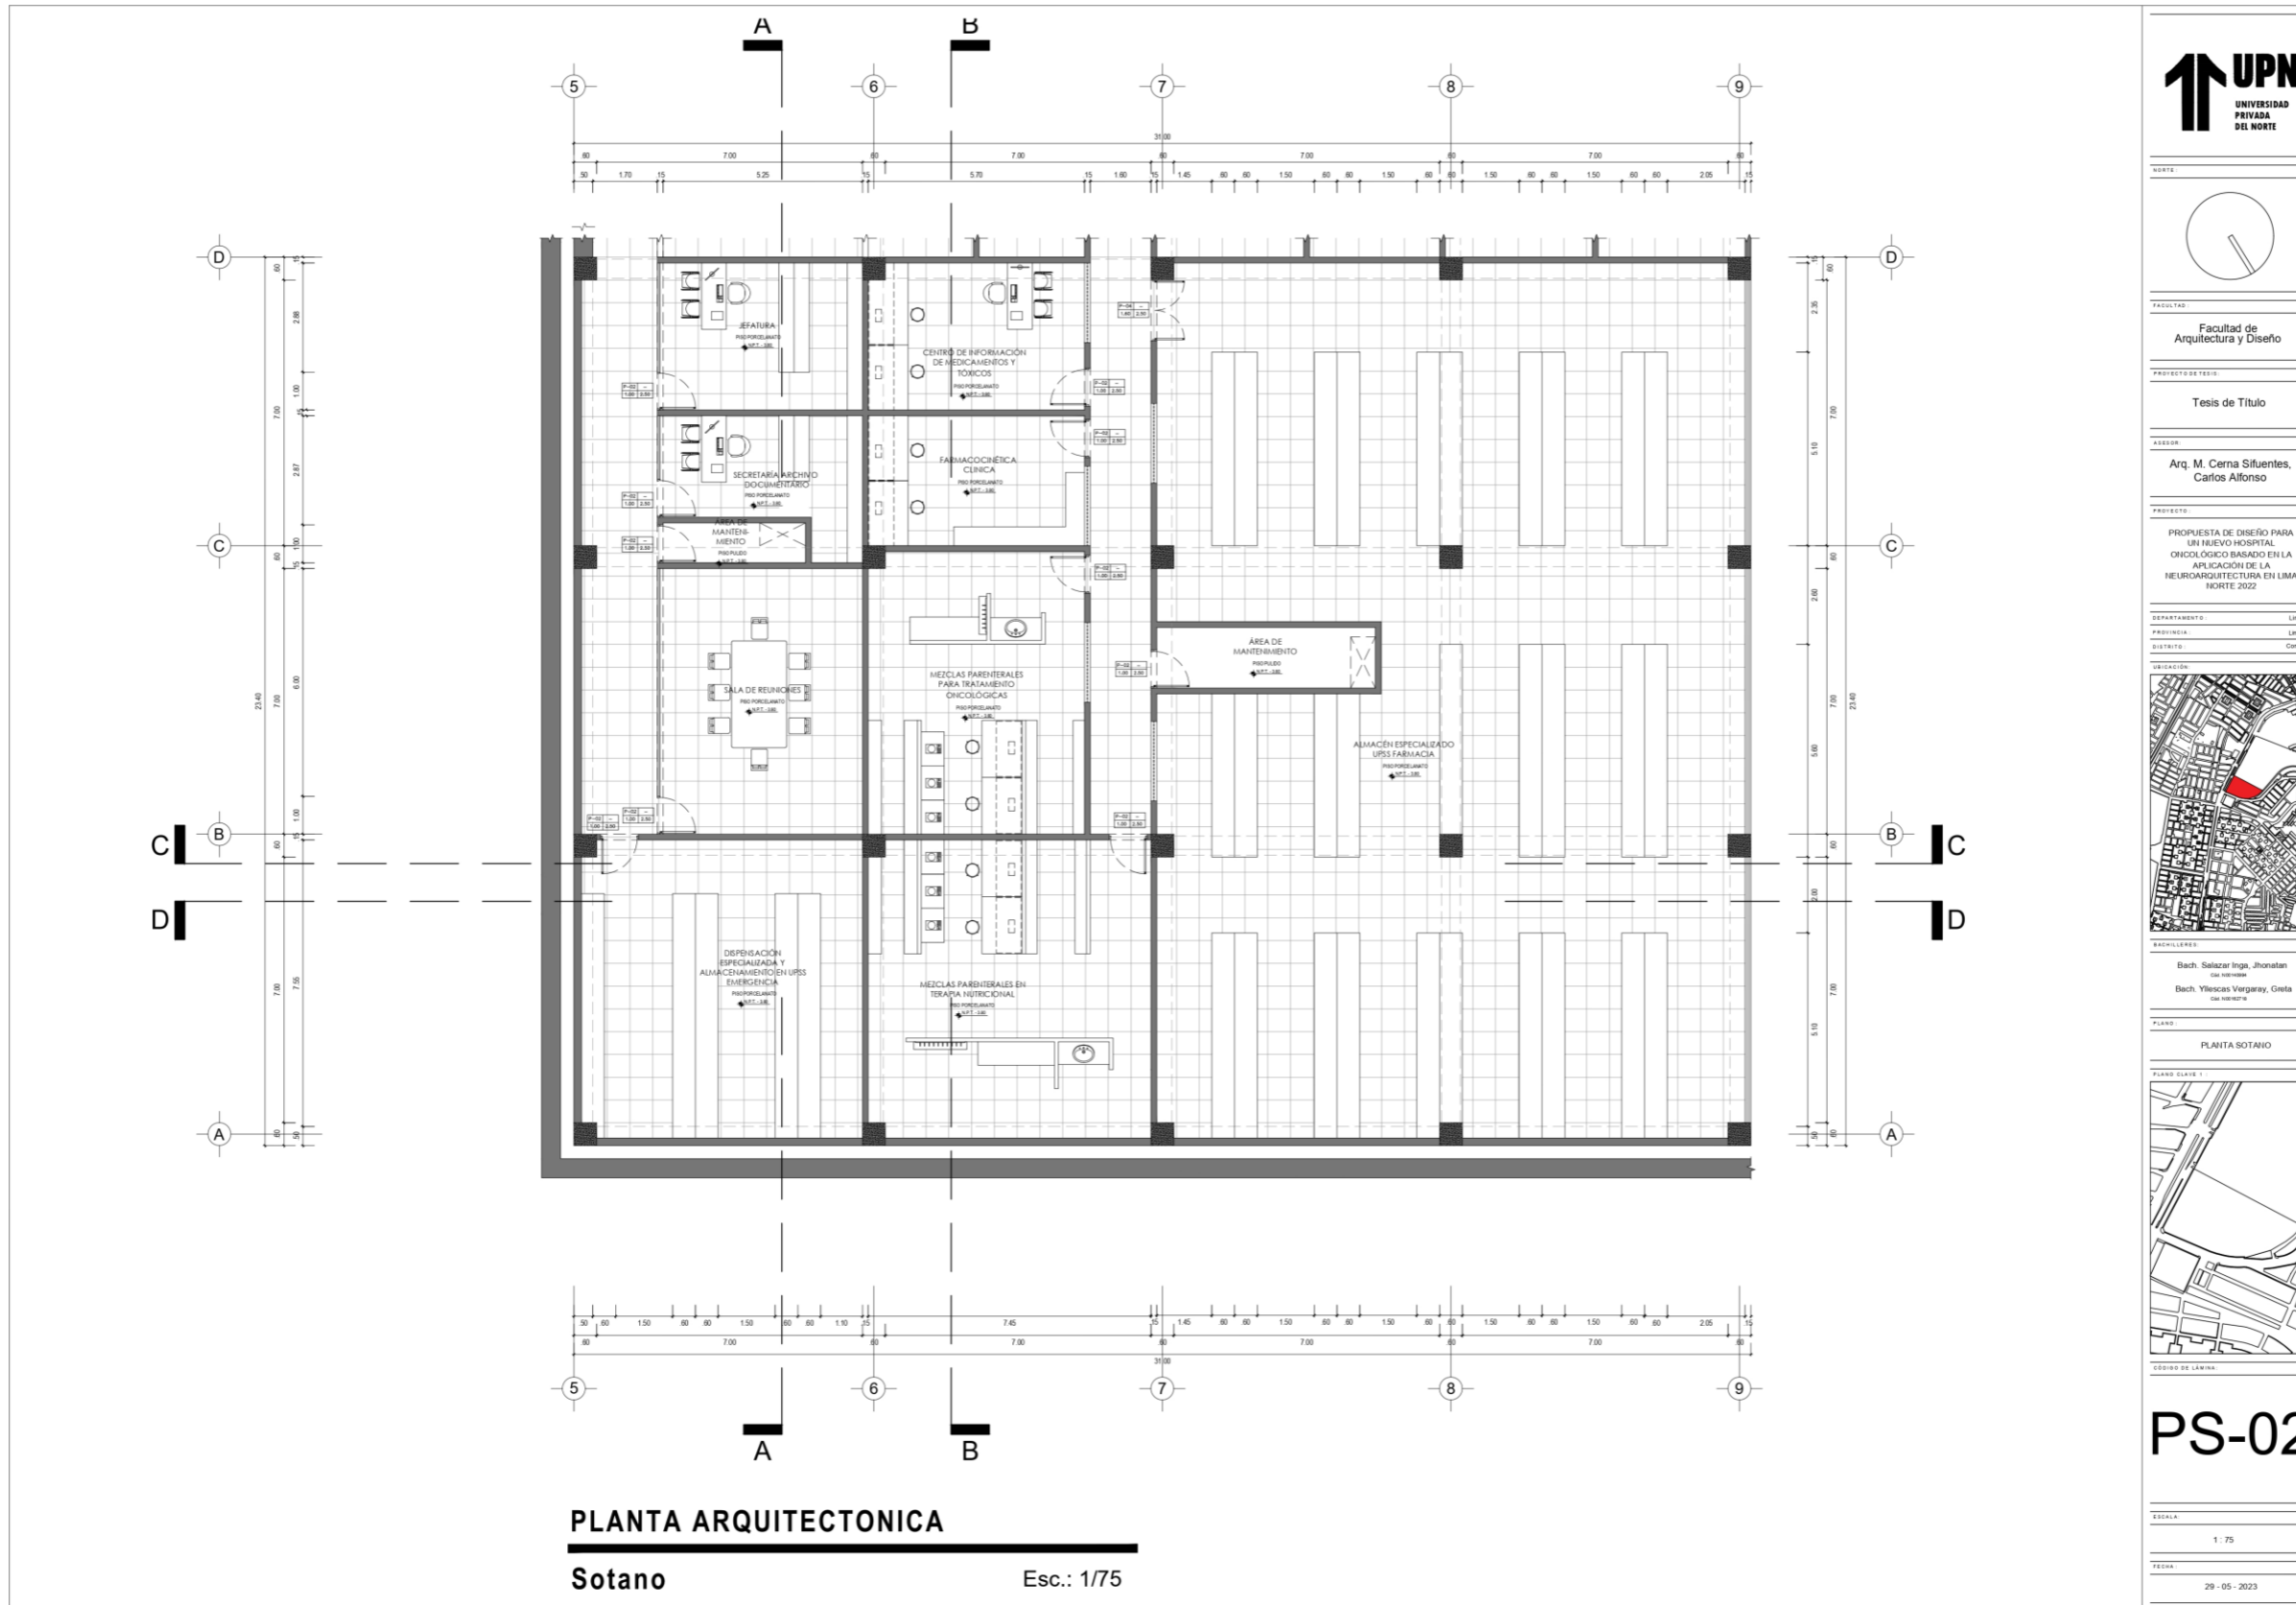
Arquitectura –Planta Sótano N°1 del sector cuadrante Esc: 1/75 (Fuente: Elaboración propia de los coautores)
